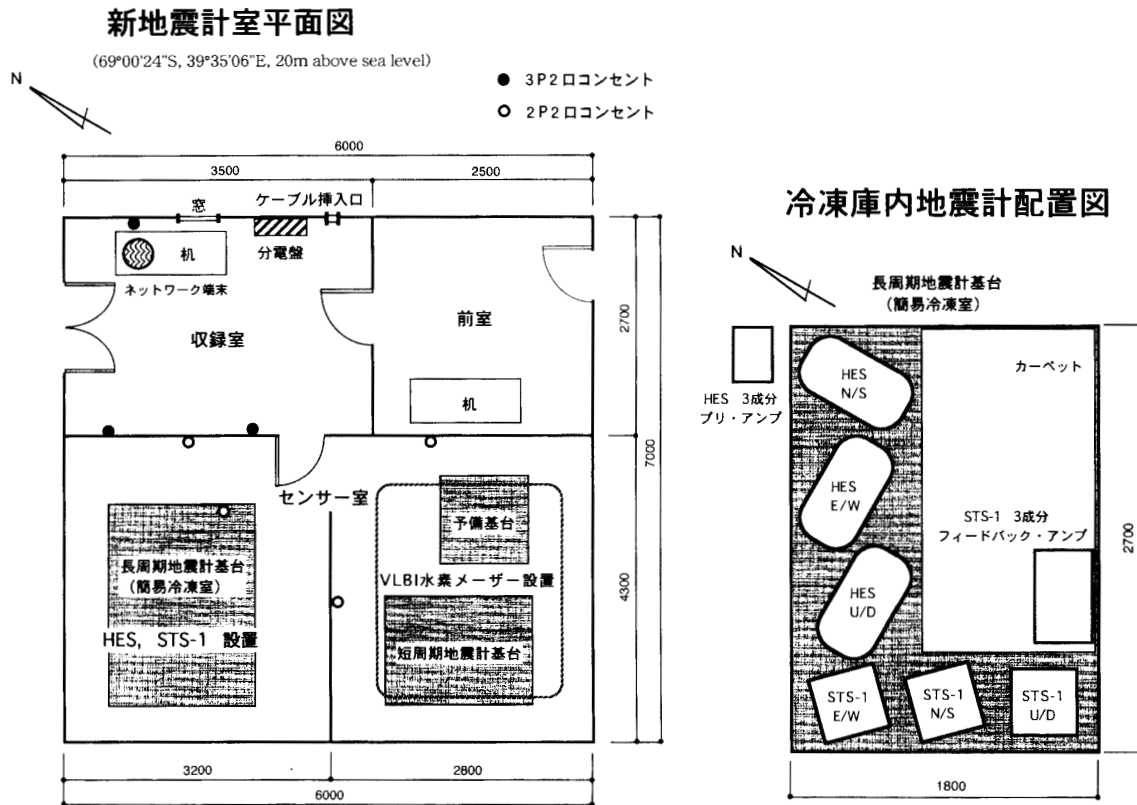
新地震計室平面図(左)と冷凍庫内地震計配置図(右)
